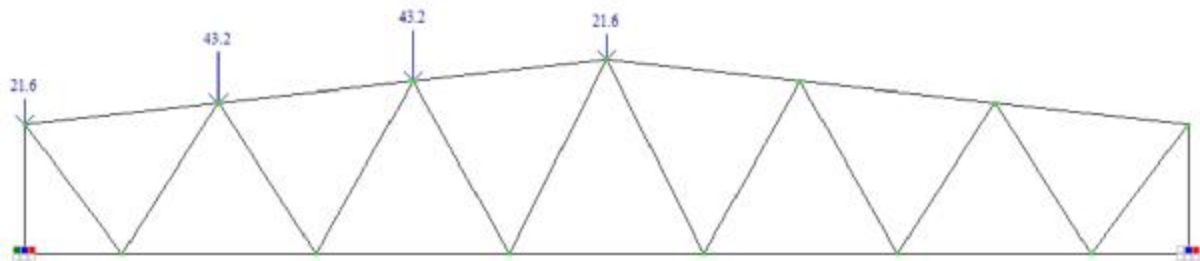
Третье загрузжение – снеговая нагрузка на пол-пролета
